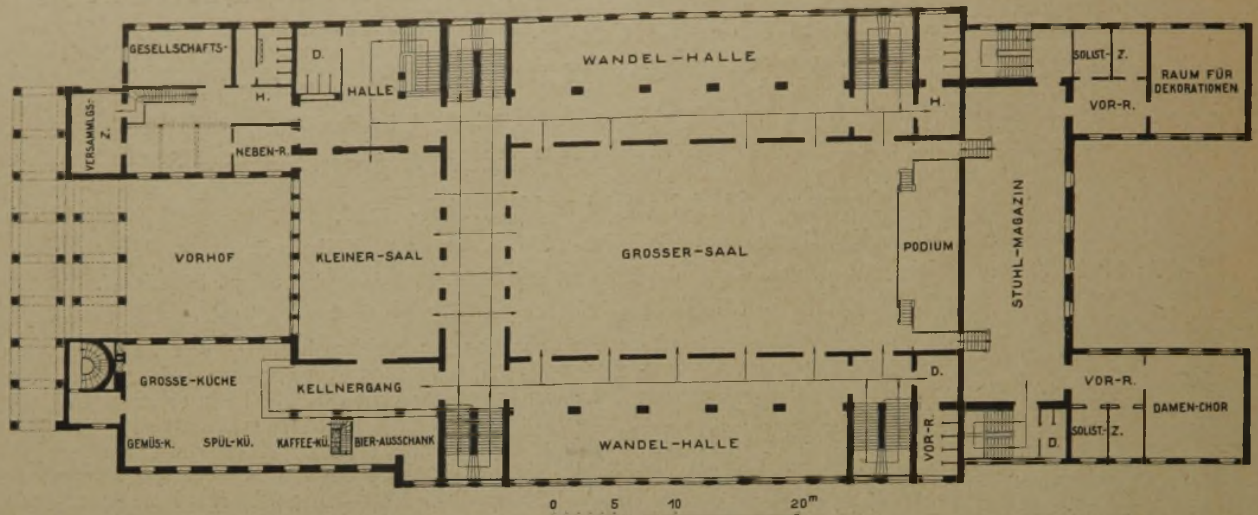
Grundriß. Saalgeschoß (rd. 1 : 600).
